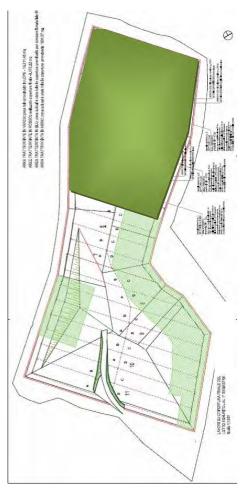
Planimetria stato avanzamento lavori di copertura finale
